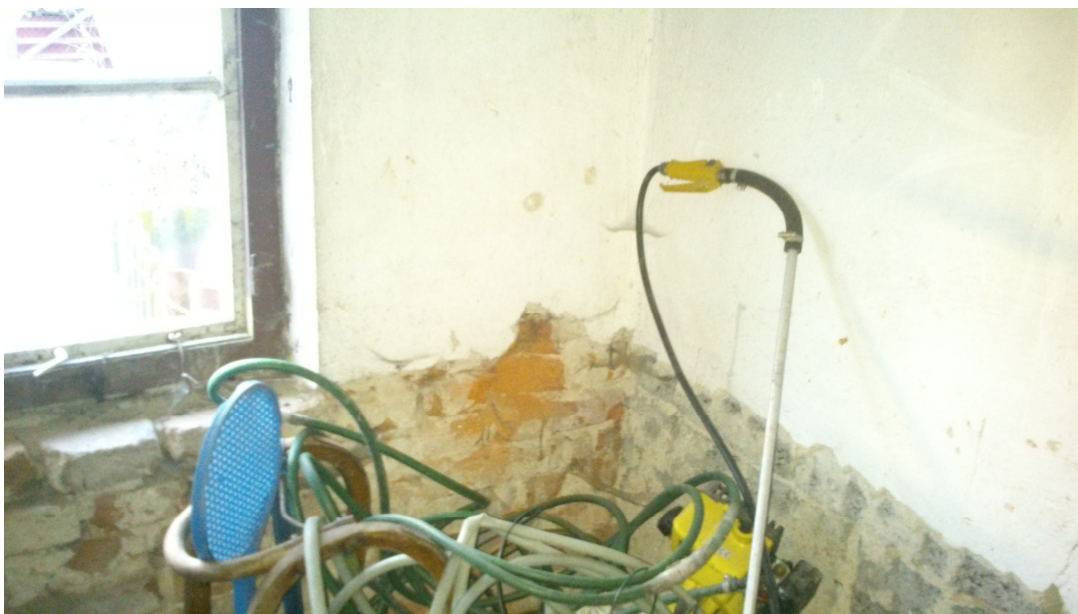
Vzorek č. 2; pohled B – Stará část maštale („Foto Sandra Studená“)
